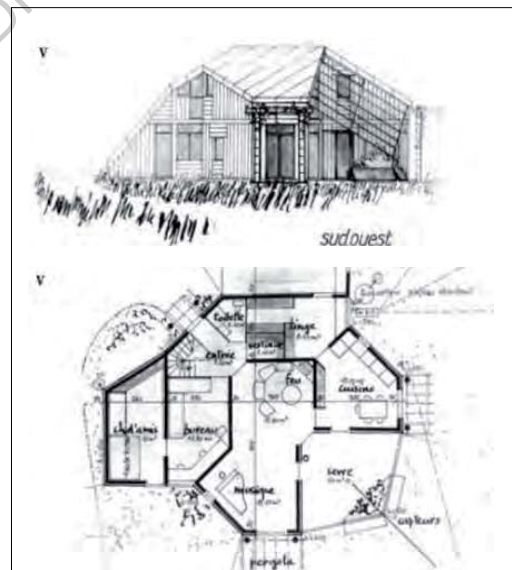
Plans et élévations de la Maison M à Muret, 1975
